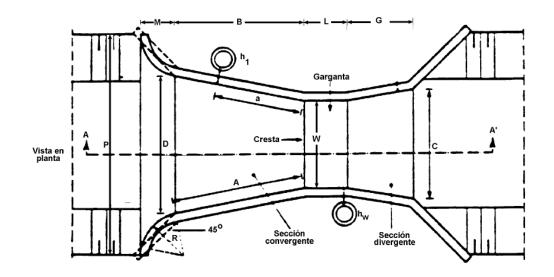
Canal Parshall vista en planta. (César, 2003)
